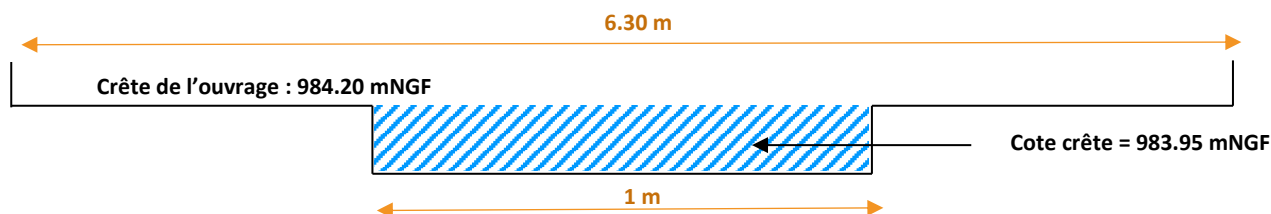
Profils en travers schématique de l'ouvrage principal
